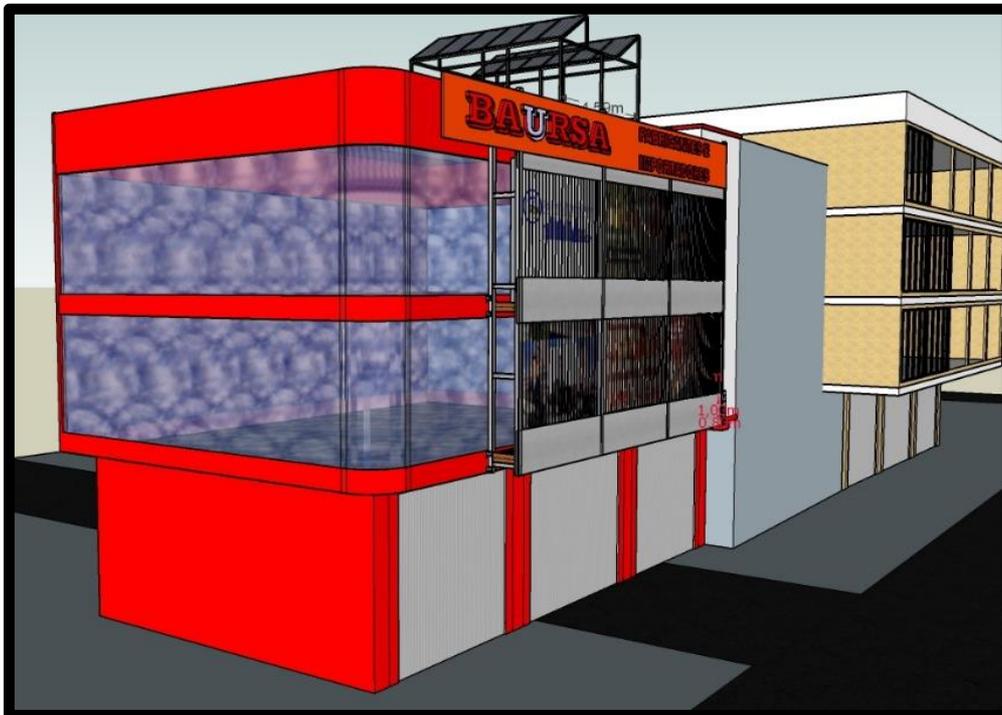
Edificio con sistema de doble fachada, vista esquinera.
